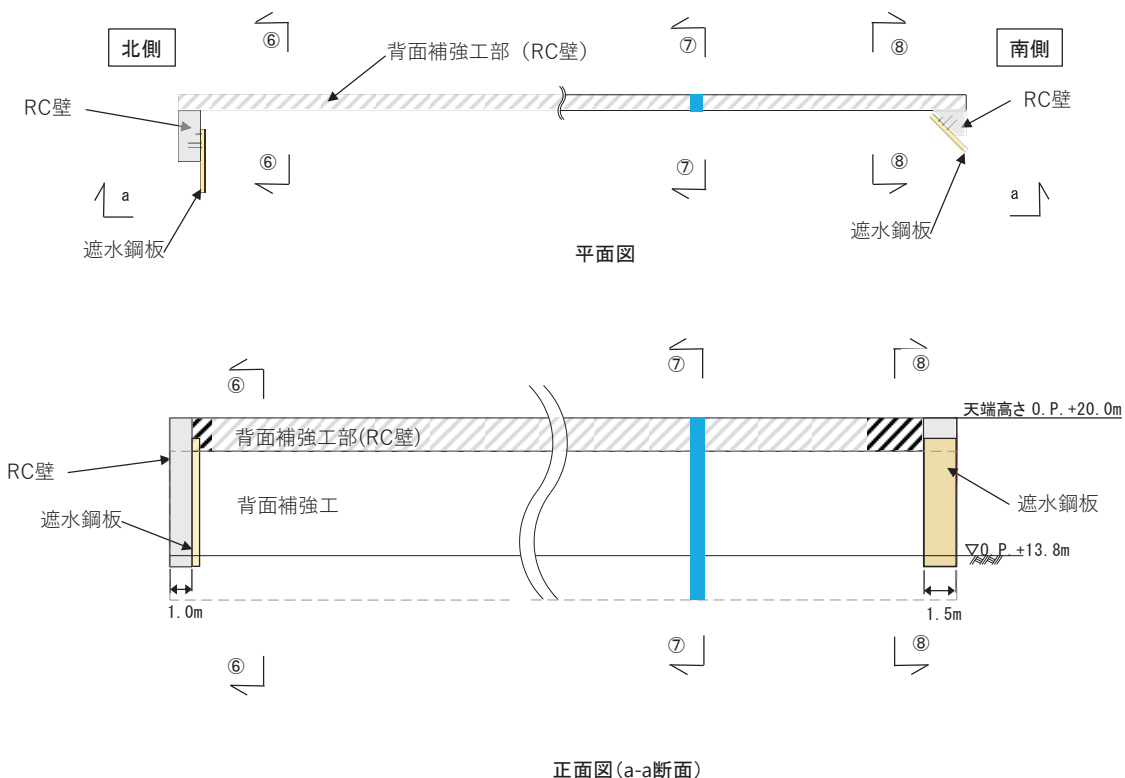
(1) 止水パターン⑥, ⑦, ⑧の構造概要(平面図, 正面図)
